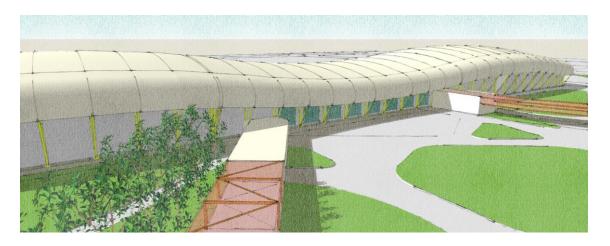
Vista de la volumetría de la Planta Empacadora de arándanos.
